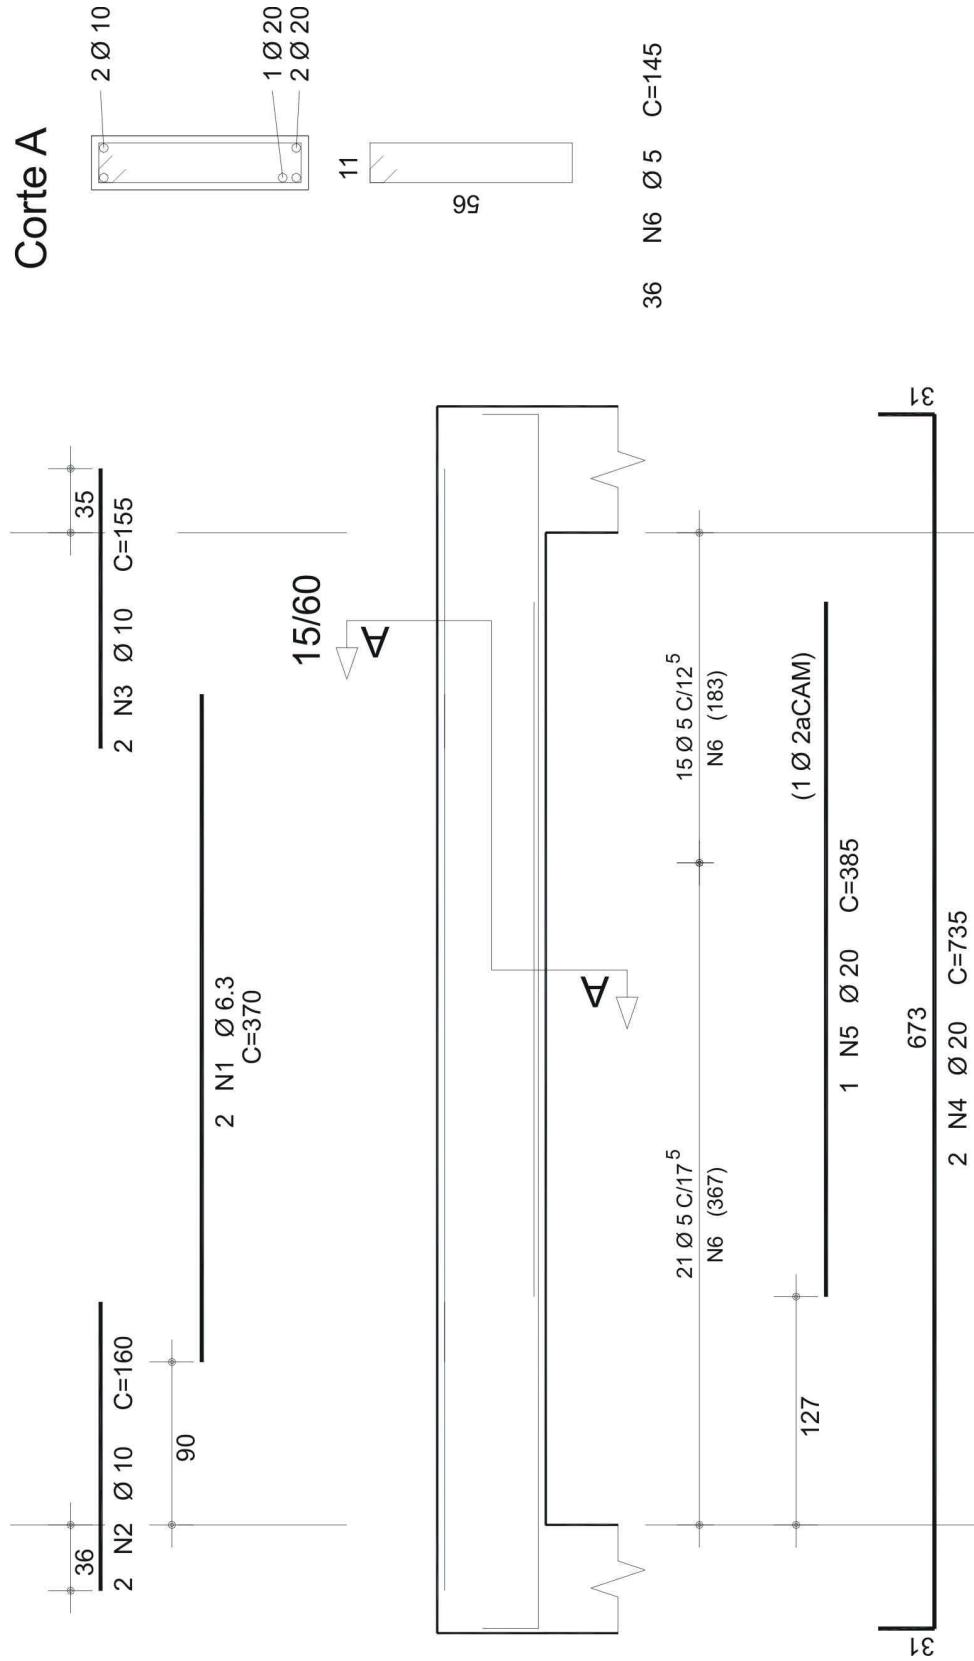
Detalhamento Viga 01, realizado pelo CAD/TQS.
